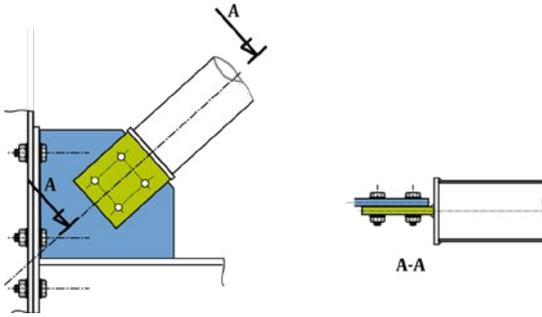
Assemblage par gousset soudé sur platine d'about pour une diagonale à section circulaire creuse
